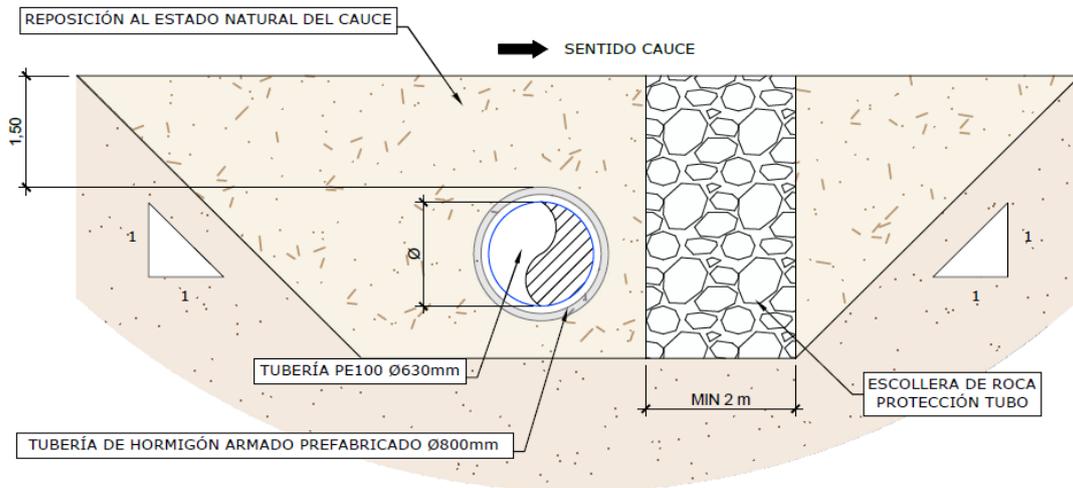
Sección tipo de cruce de tubo bajo arroyo
